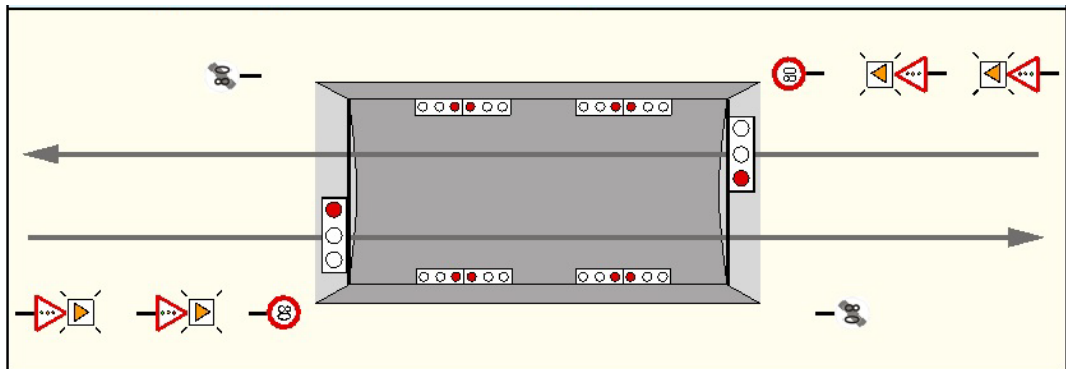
Plan de feux – Fermeture du tunnel dans les deux directions.
